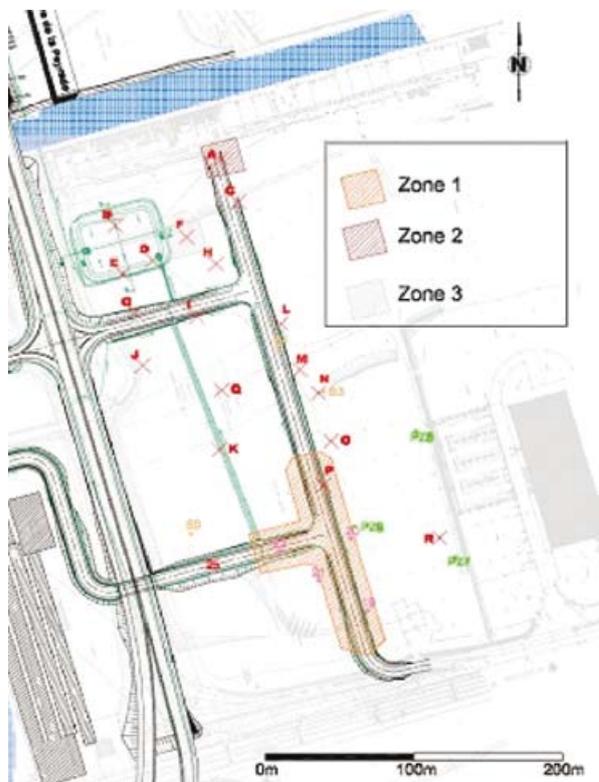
Plan de masse d'un projet d'infrastructure sur site pollué
